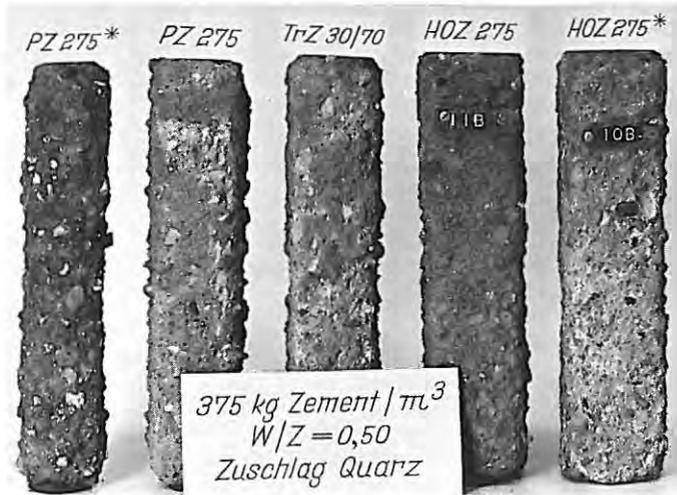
Feinbetonprismen nach 20 Jahren Lagerung in Wasser mit kalklösender Kohlensäure; Einfluß der Zementart
